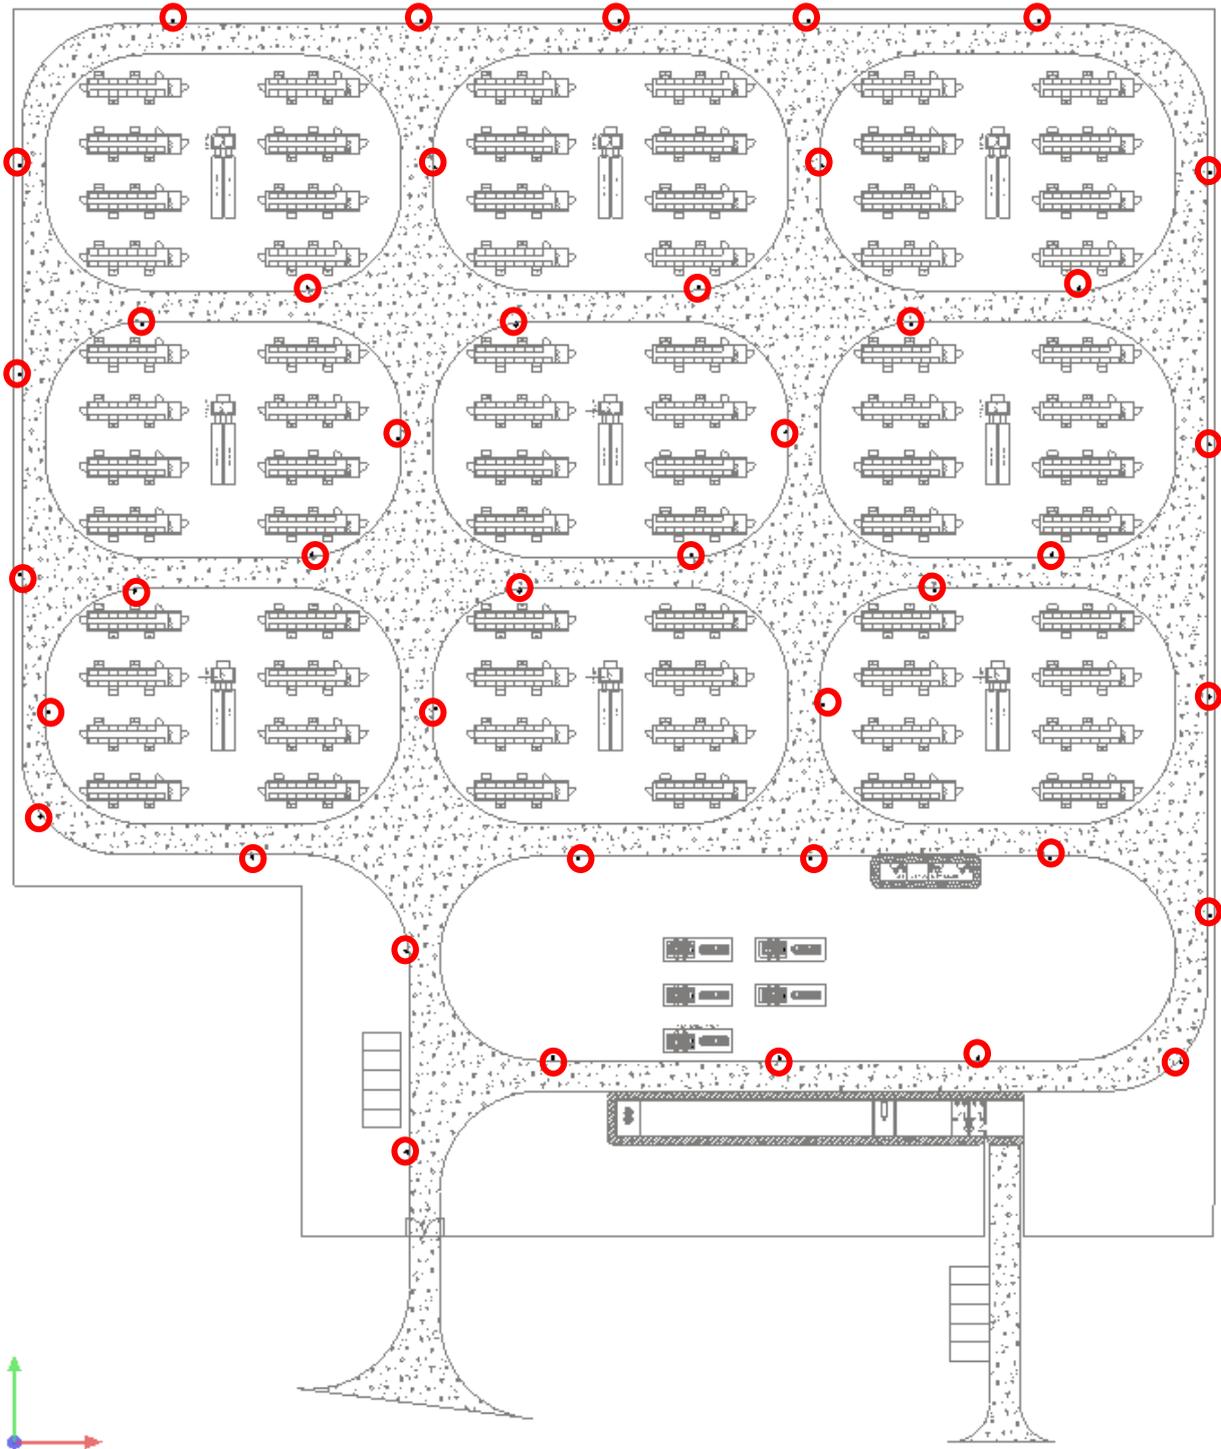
Layout area BESS con posizione dei corpi illuminanti
